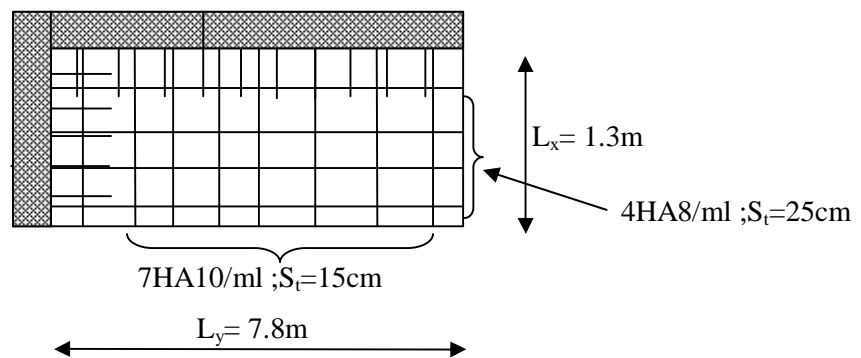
schéma de ferrailage de la dalle sur deux appuis.
